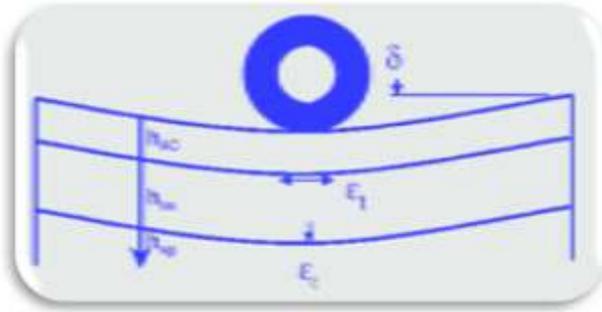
Comportamiento del Pavimento Bajo Cargas de Rueda.
